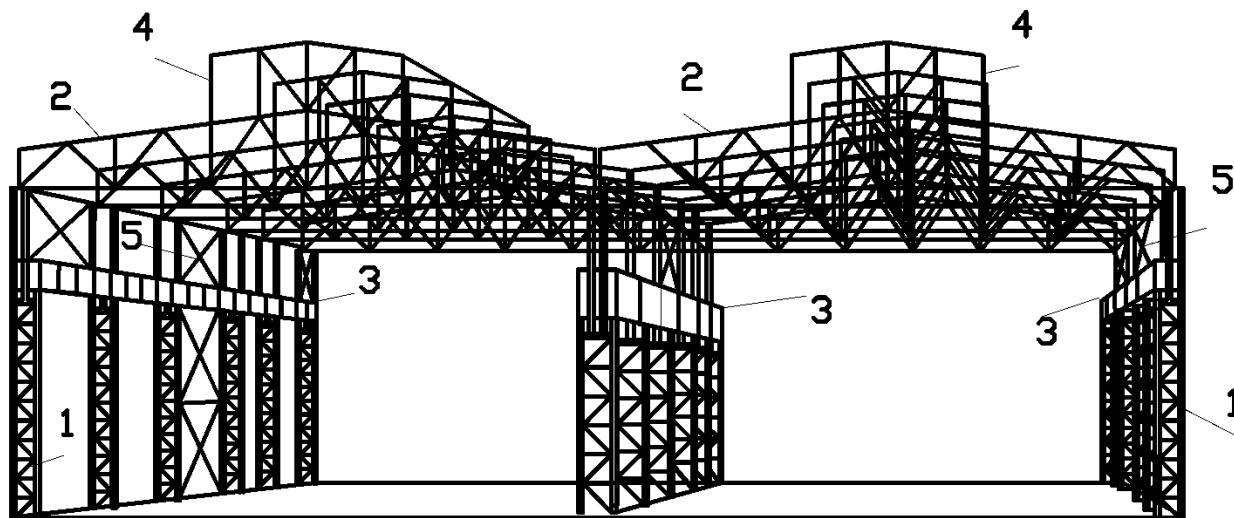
Конструктивная схема стального каркаса двух пролетного производственного здания. 1 – колонны, 2 – стропильные фермы, 3 – подкрановые балки, 4 – светоаэрационные фонари, 5-связи по колоннам
